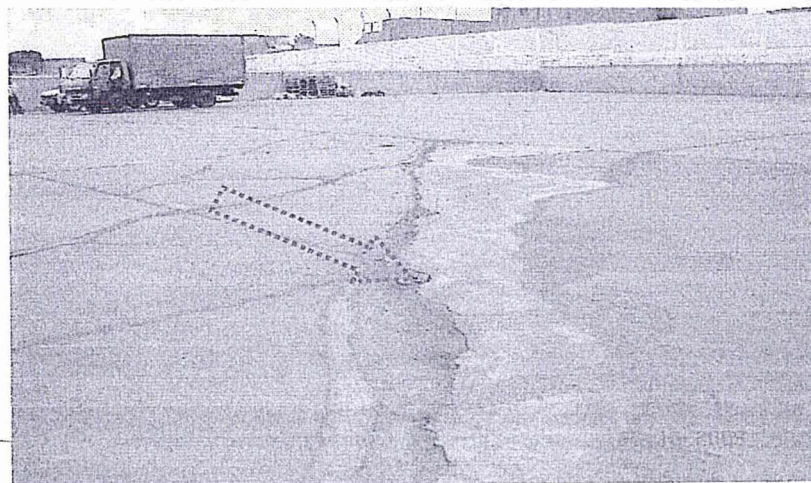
(Lev. Obs. 1 del 2008) : Las juntas de dilatación, las rajaduras y fracturas en pisos y paredes se mantienen sin haber sido reparadas
